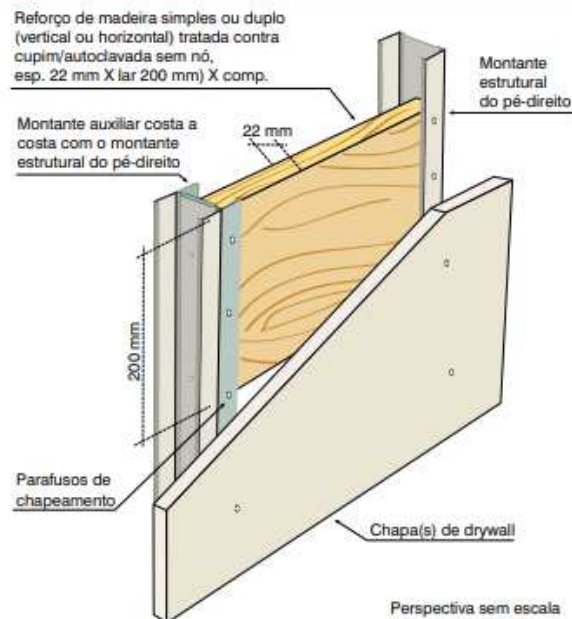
Detalhe Genérico de reforço em Drywall . (Fonte Manual Trevo Drywall)
